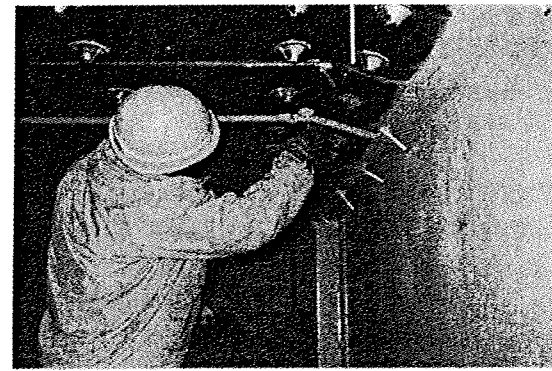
シール材充填、注入パイプ取り付け状況
